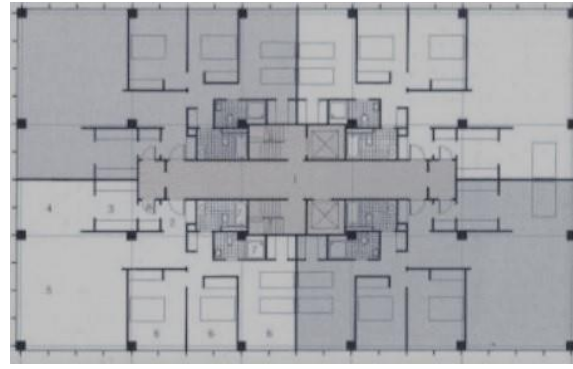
PLANTA LAKE SHORE DRIVE APARTMENT. FUENTE:
